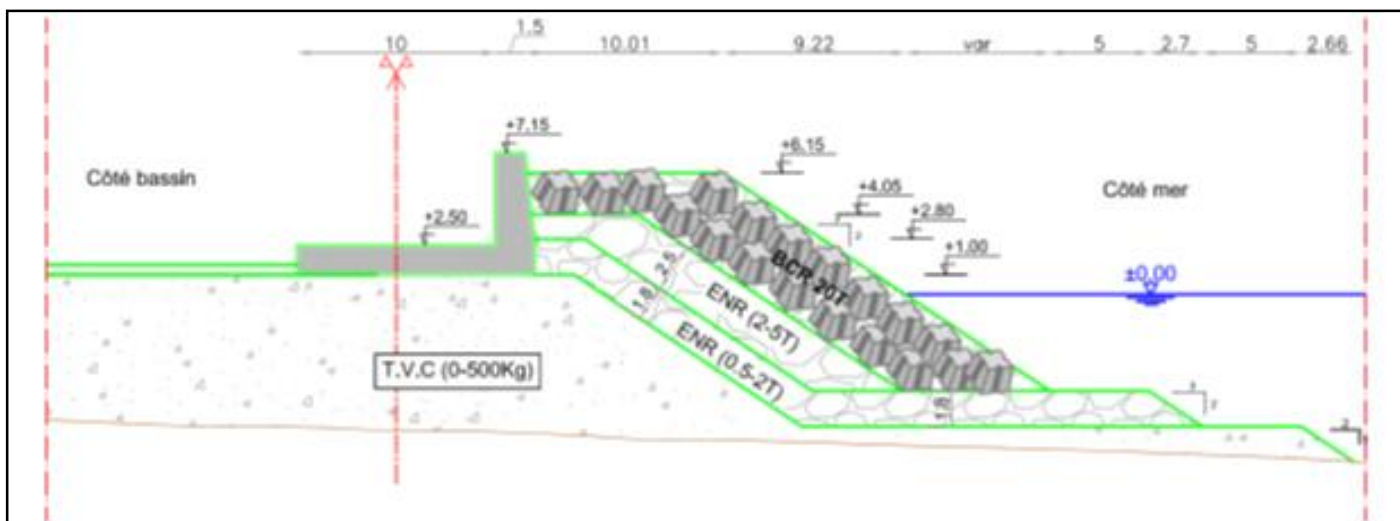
Variante 01 – jetée secondaire – profil courant B
